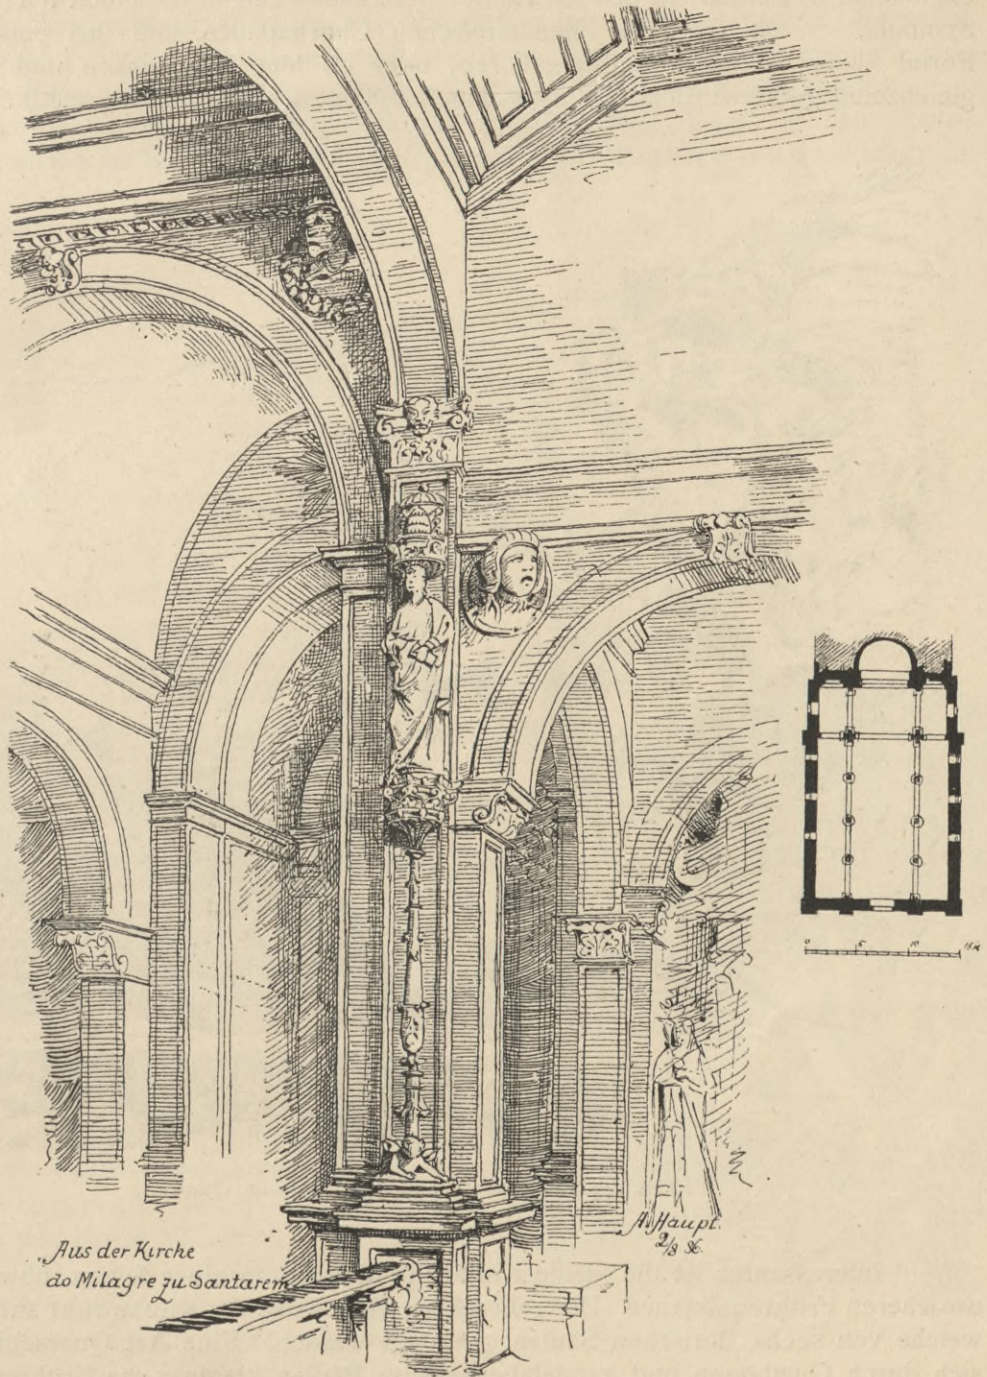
Inneres und Grundriss der Kirche do Milagre zu Santarem.
